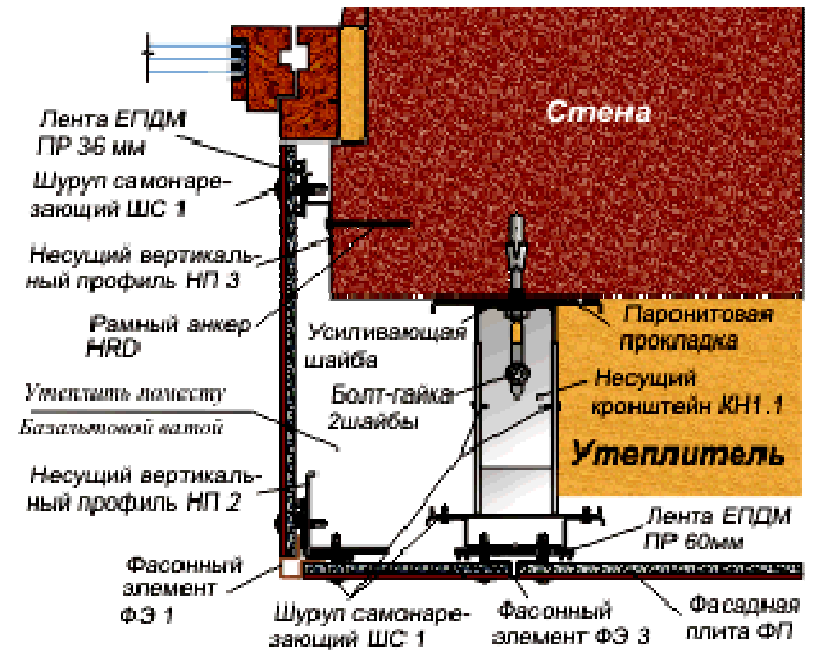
Крепления фасадной плиты на угол здания (2-й вариант)
